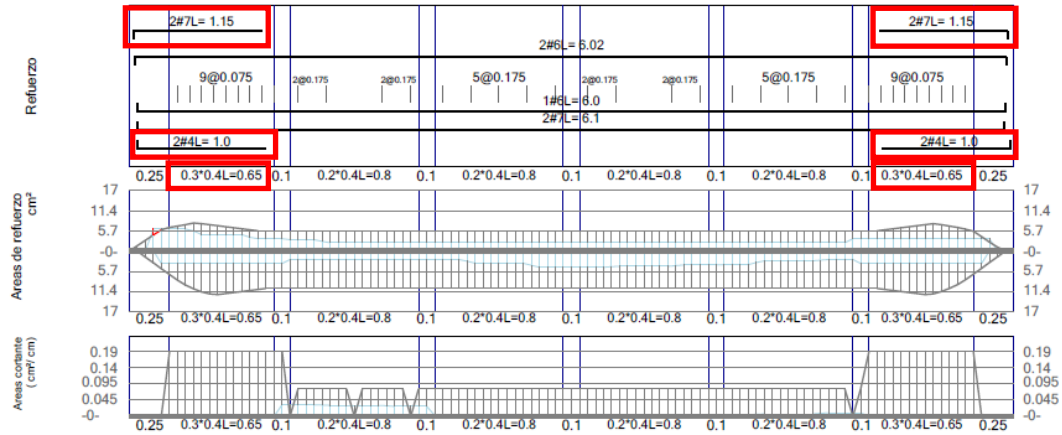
Ensanchamientos en vigas, Fuente: Propia
